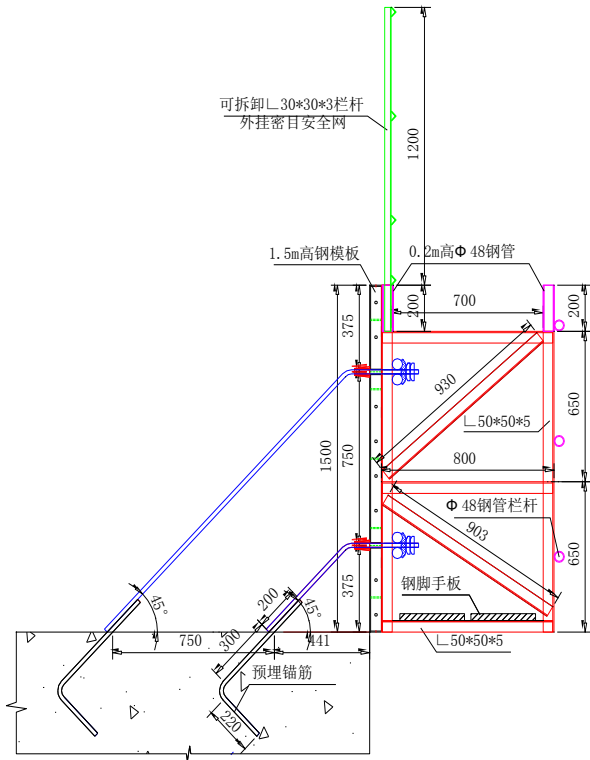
模板钢架施工平台布置侧立面图 (单位: mm)
